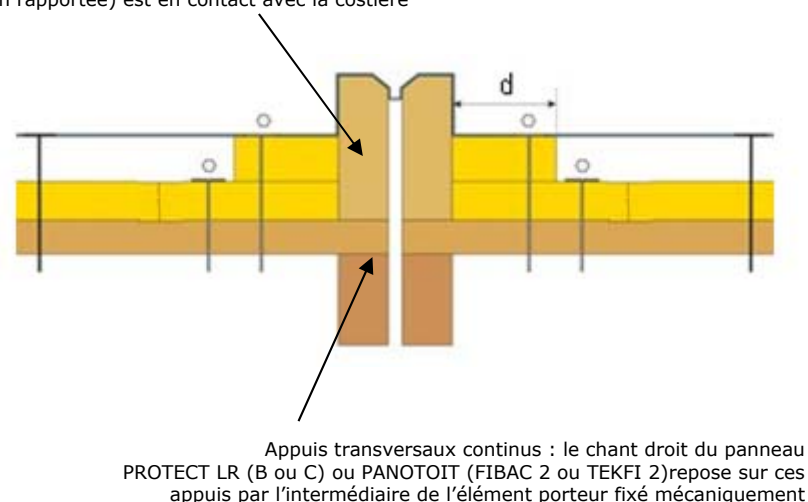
Exemple de traitement au droit d'un joint de dilatation sur élément porteur bois - panneaux à base de bois, reposant sur deux appuis transversaux continus
